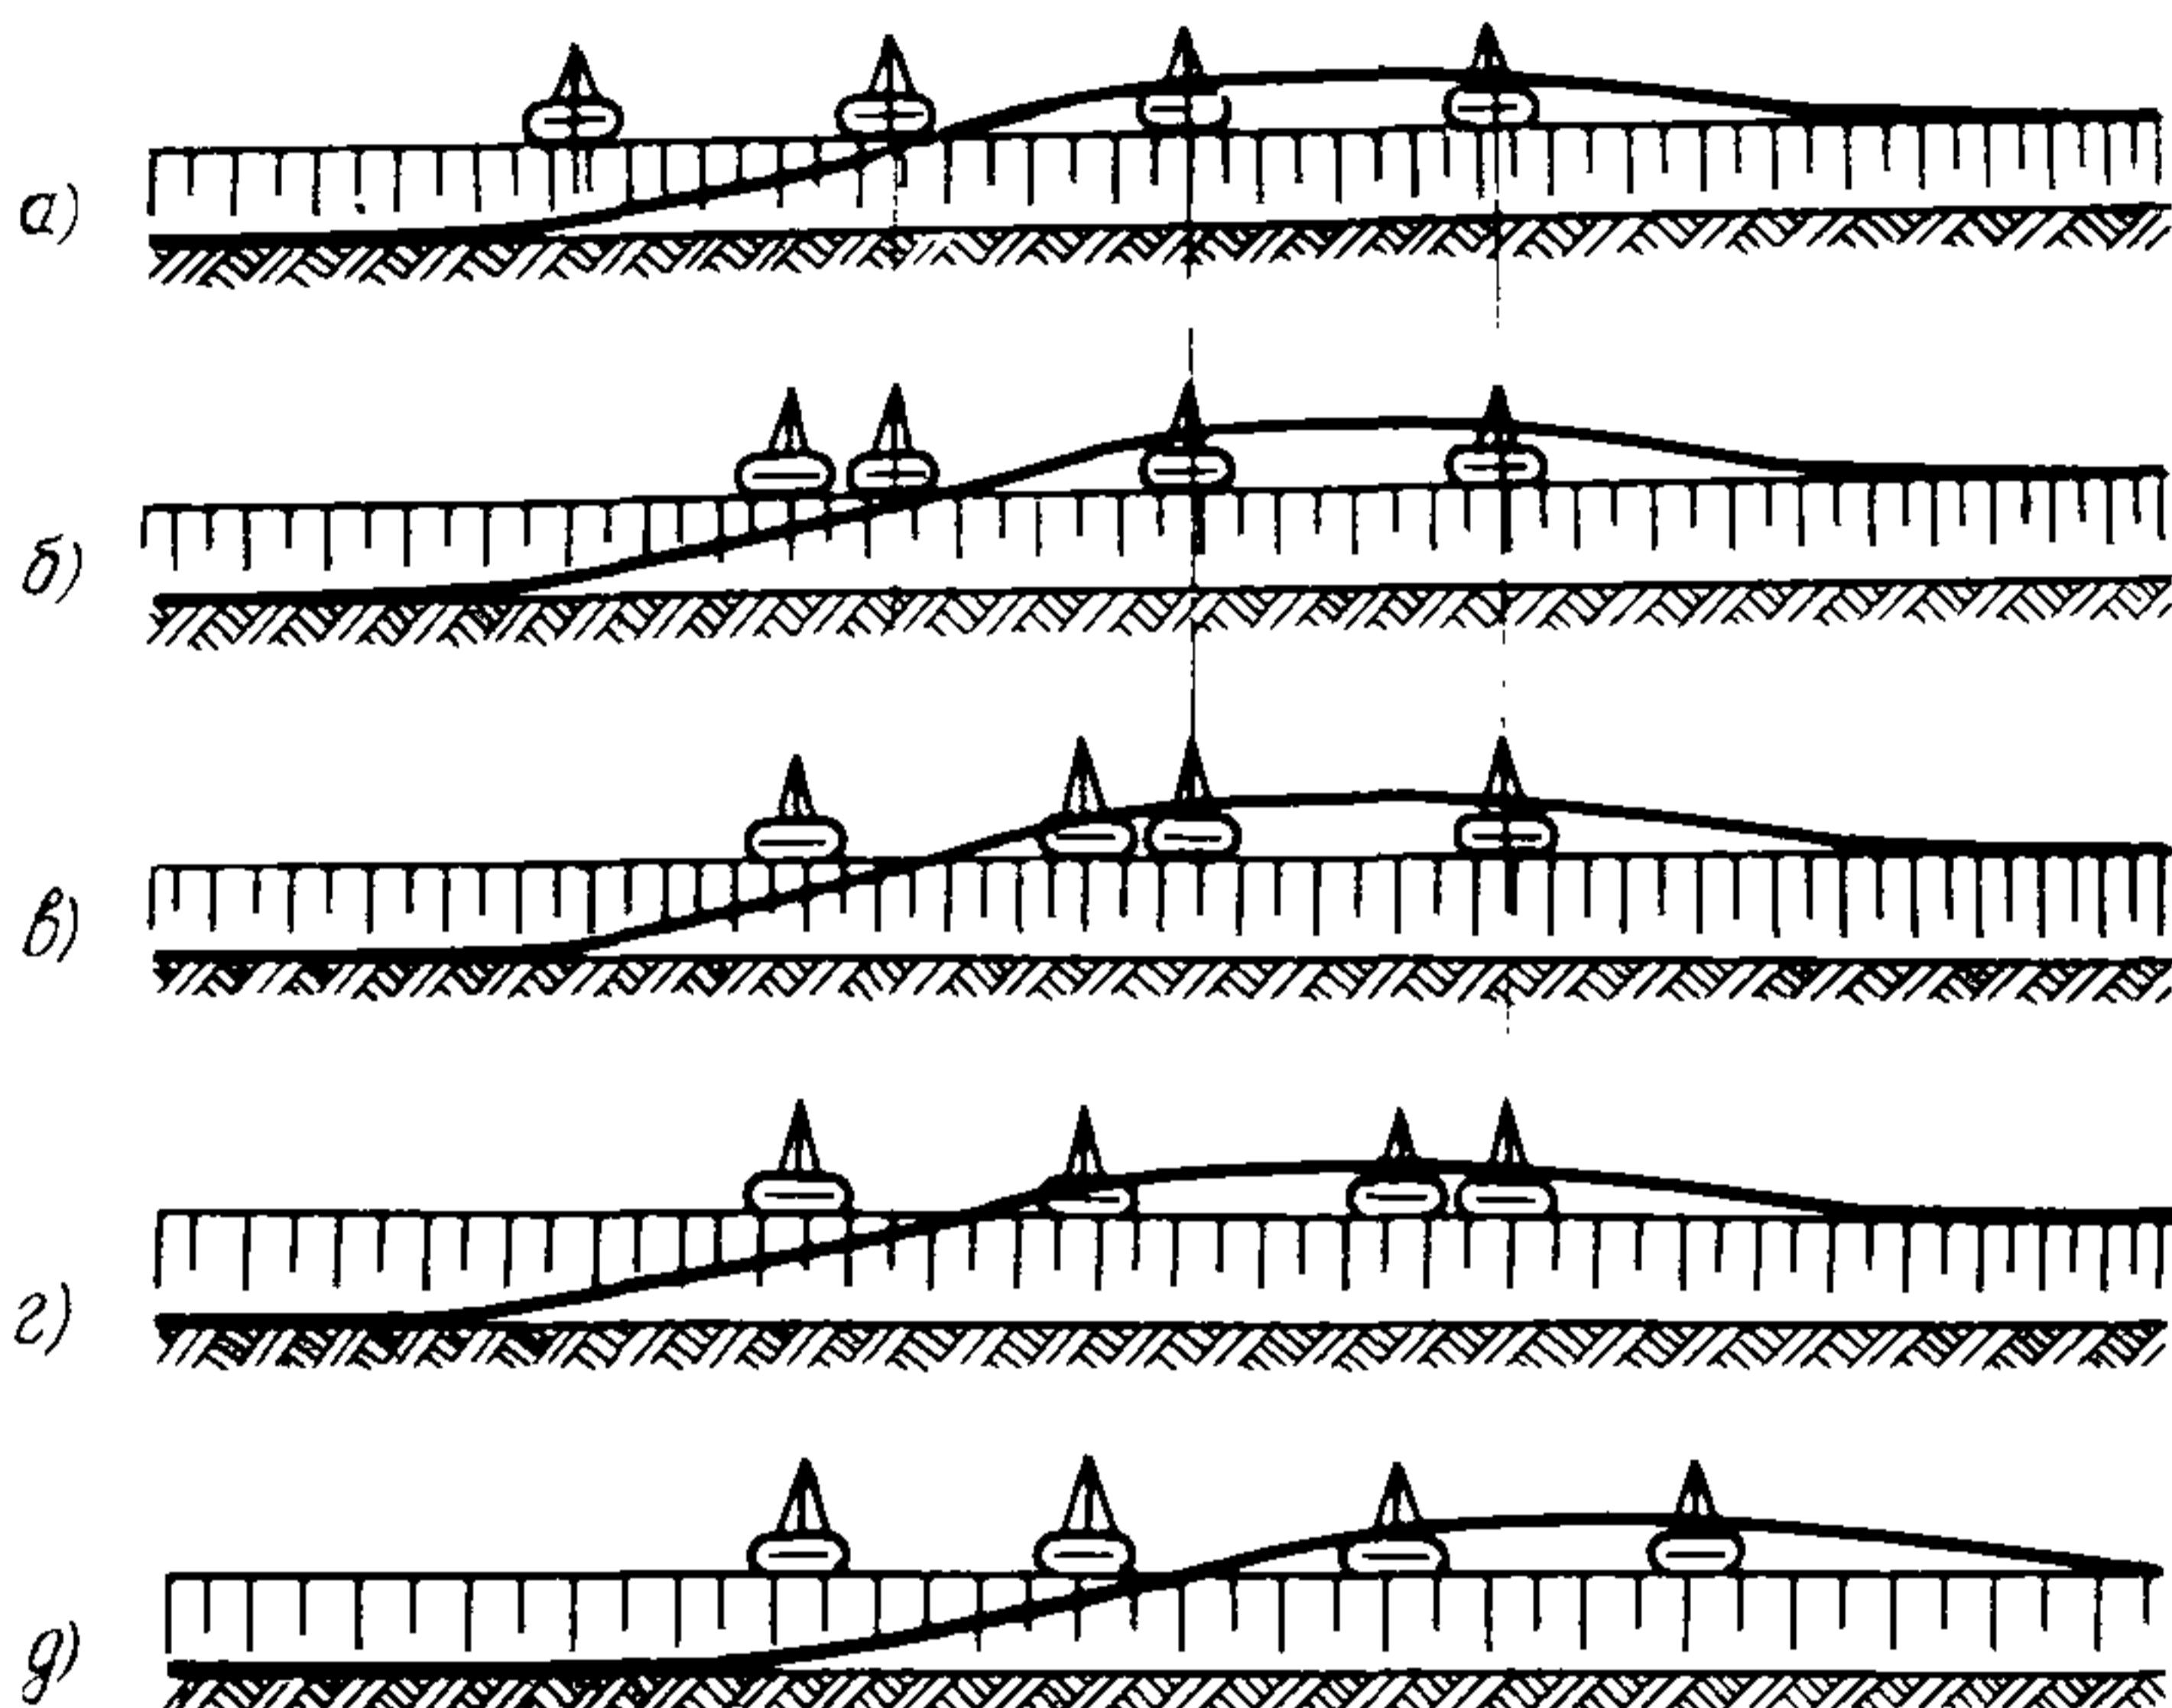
Схема укладки изолированного труоопровода с помощью оснащенных мягкими полотенцами трубоукладчиков
